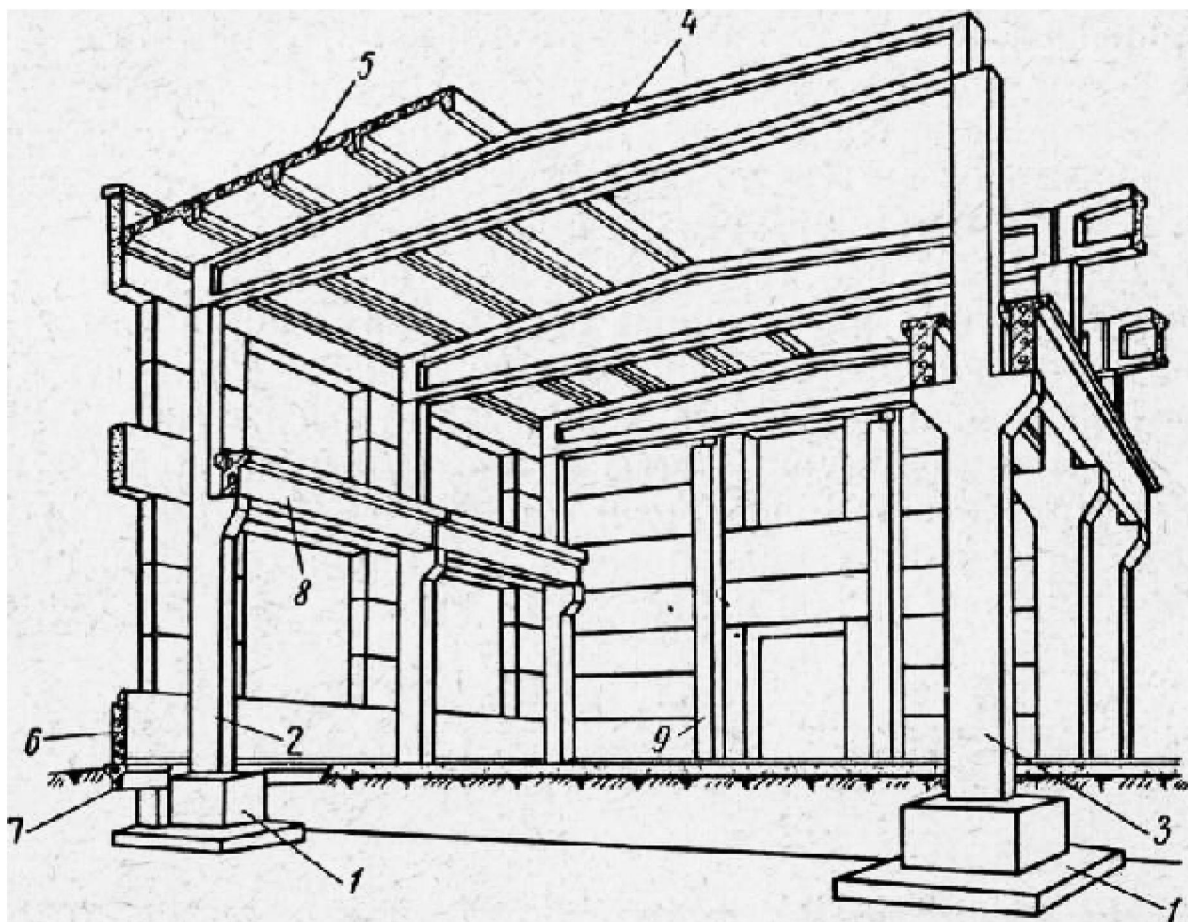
Промышленное здание из сборного железобетона (1 – фундамент, 2 – колонна крайнего ряда, 3- колонна среднего ряда, 4 – двускатная балка, 5- ребристые плиты покрытия, 6 – стеновая панель, 7 – фундаментная балка, 8 – подкрановая балка, 9 – фахверковая колонна). [61]
